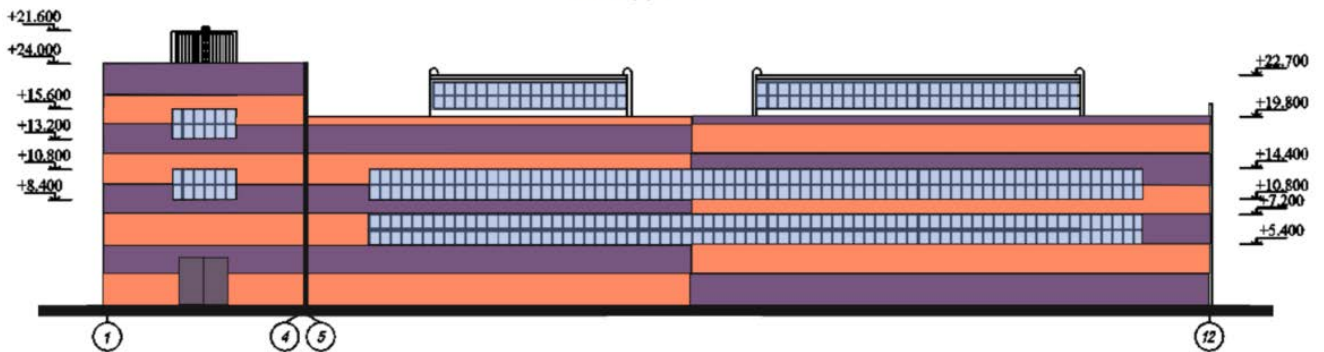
Схема розкладання стінових панелей фасаду 1-12.
